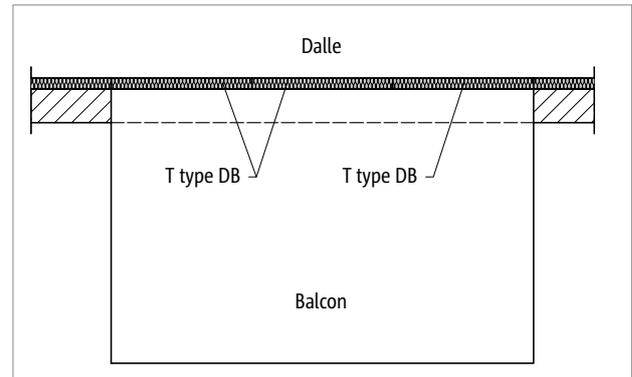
Schöck Rutherma® T type DB : balcon en porte-à-faux et plancher constitué de prédalles
